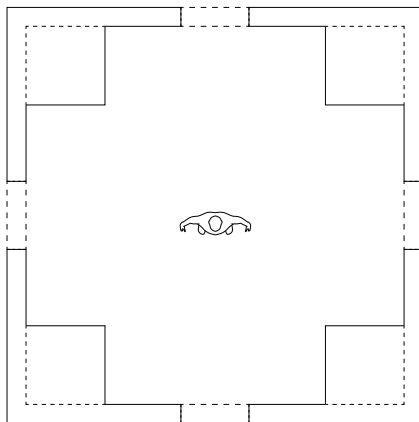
Pos. I.V | Grundriss – M.1:100
